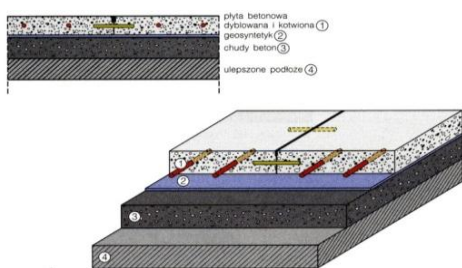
Układ warstw w konstrukcji nawierzchni z betonu cementowego
